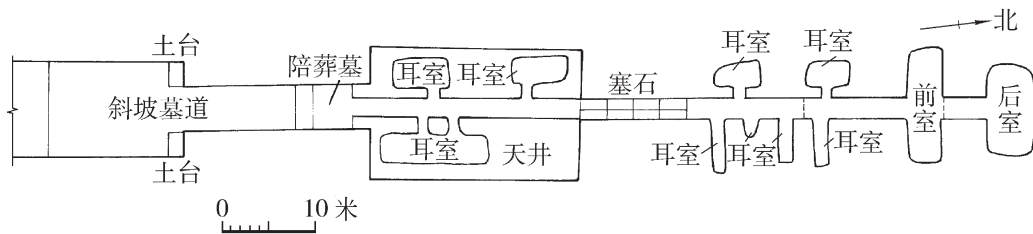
江苏省徐州市狮子山汉墓平面图 (1/800)
